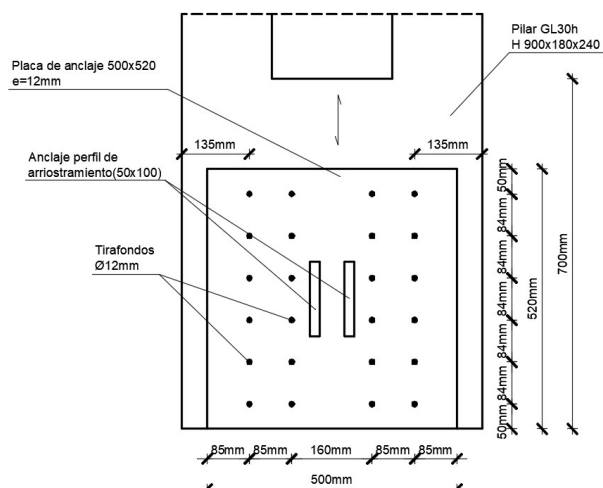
Detalle de la disposición de los elementos de fijación.
